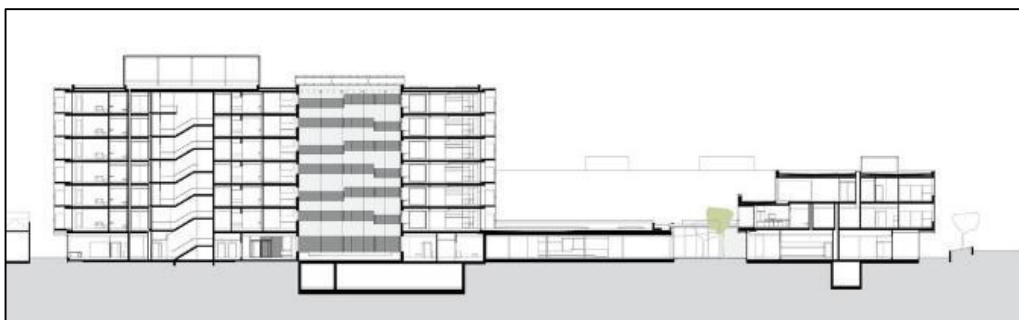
Corte longitudinal del Centro Geriátrico Donaustadt Viena
